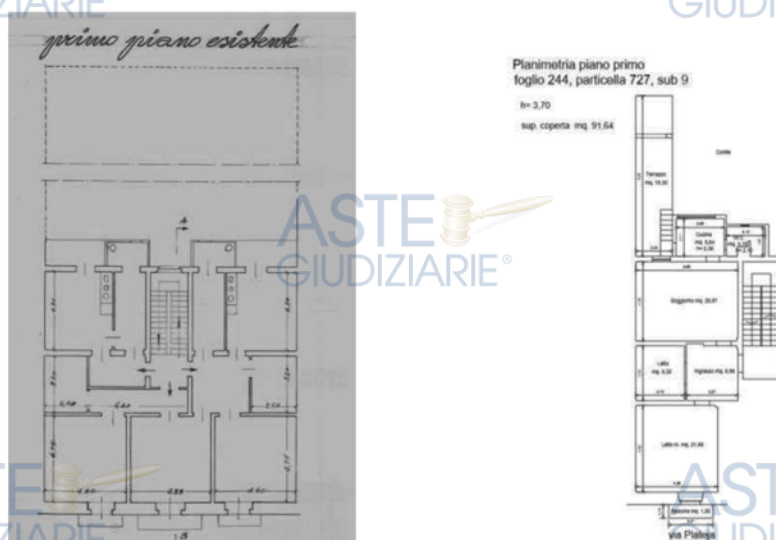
Confronto fra la planimetria dell'ultimo progetto assentito e la planimetria rilevata
